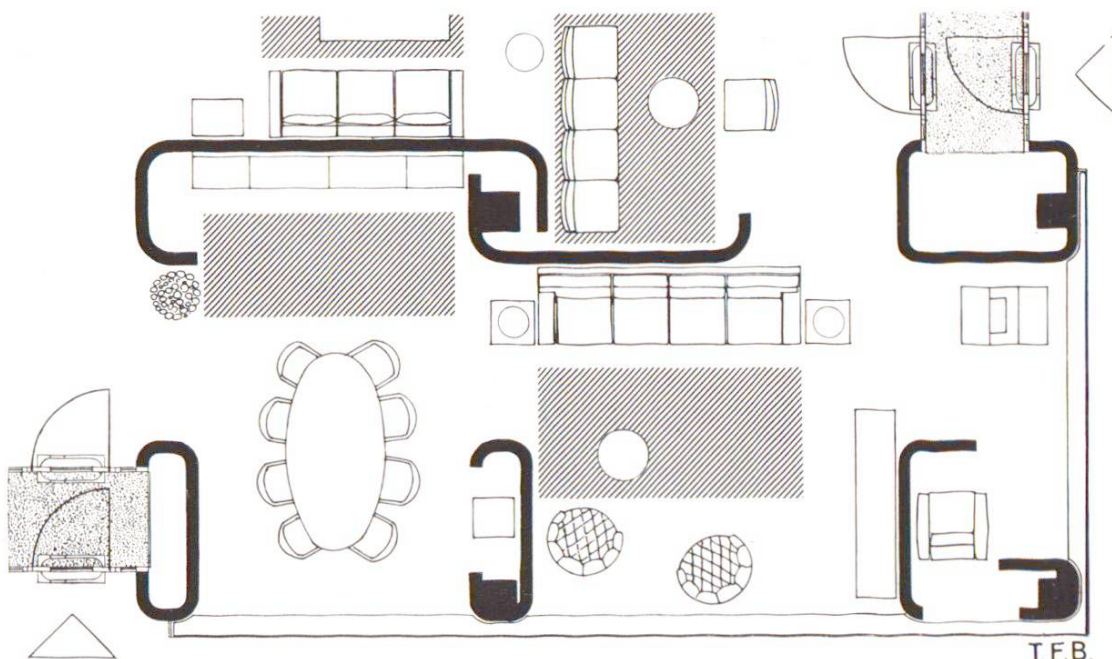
Ausschnitt aus dem Grundriss der Ausstellungsräume mit den zu Nischen gewölbten Beton-Trennwänden (etwa  $\frac{1}{4}$  der Gesamtgrundfläche).
